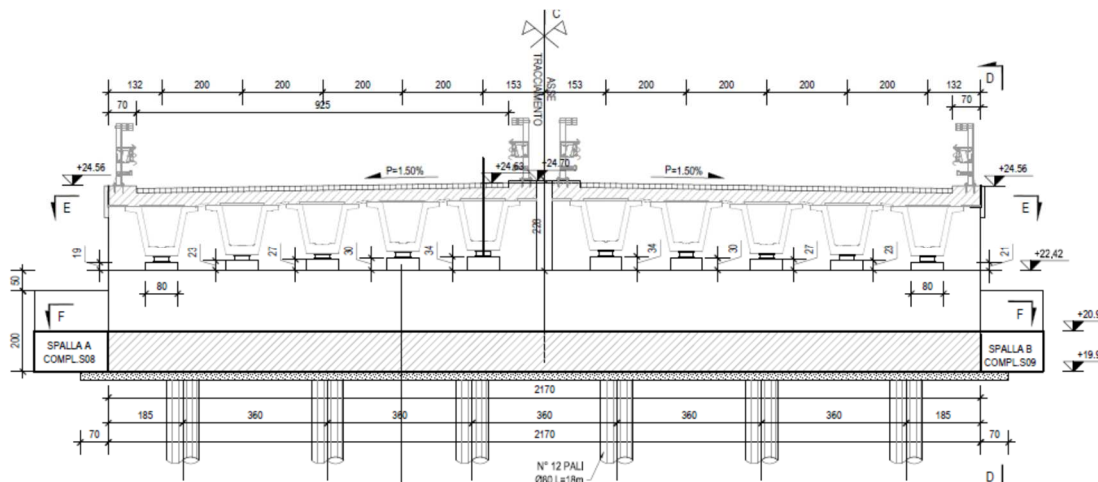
Sezione di carpenteria - Spalla tipo
